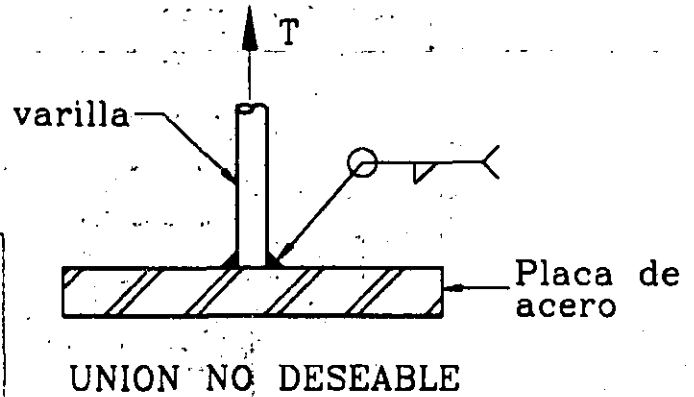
Soldadura de las varillas de refuerzo
